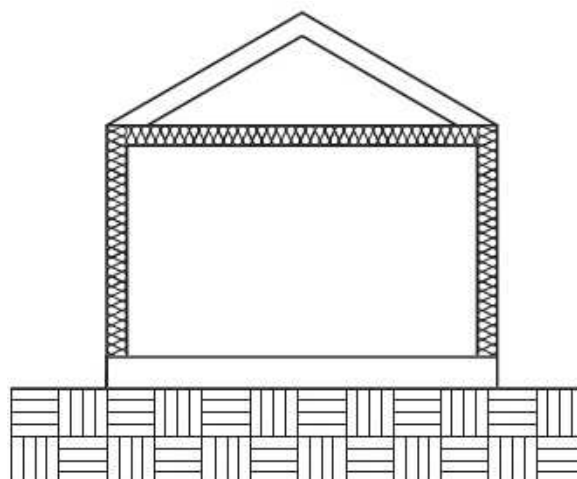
Envelope de isolamento térmico na edificação. [adaptado de ALLEN e THALLON (2011)]
